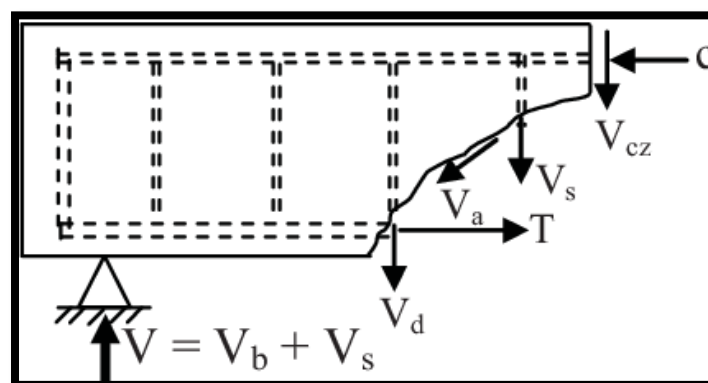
Forces internes dans une poutre avec armatures transversales (Ameziane ,2011)
